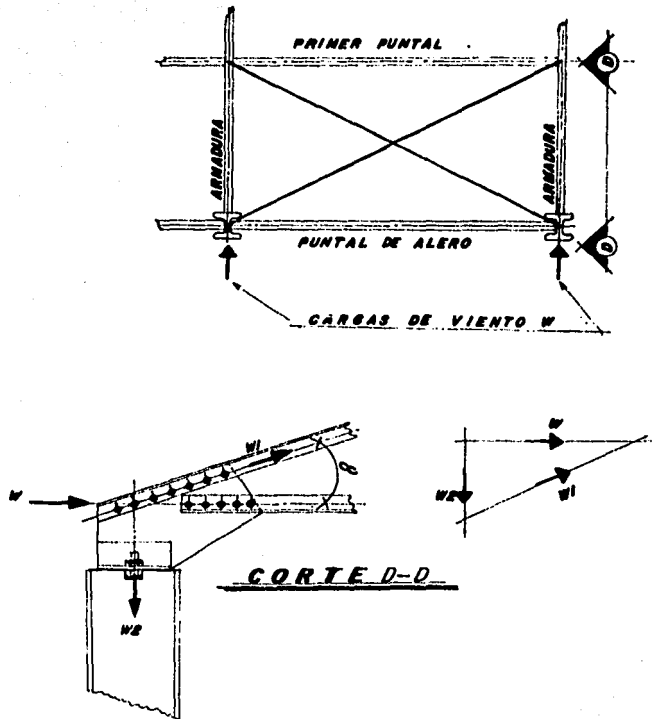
Carga en la viga longitudinal de arriostramiento que se encuentra en el plano de la cuerda superior de la armadura de techo.
